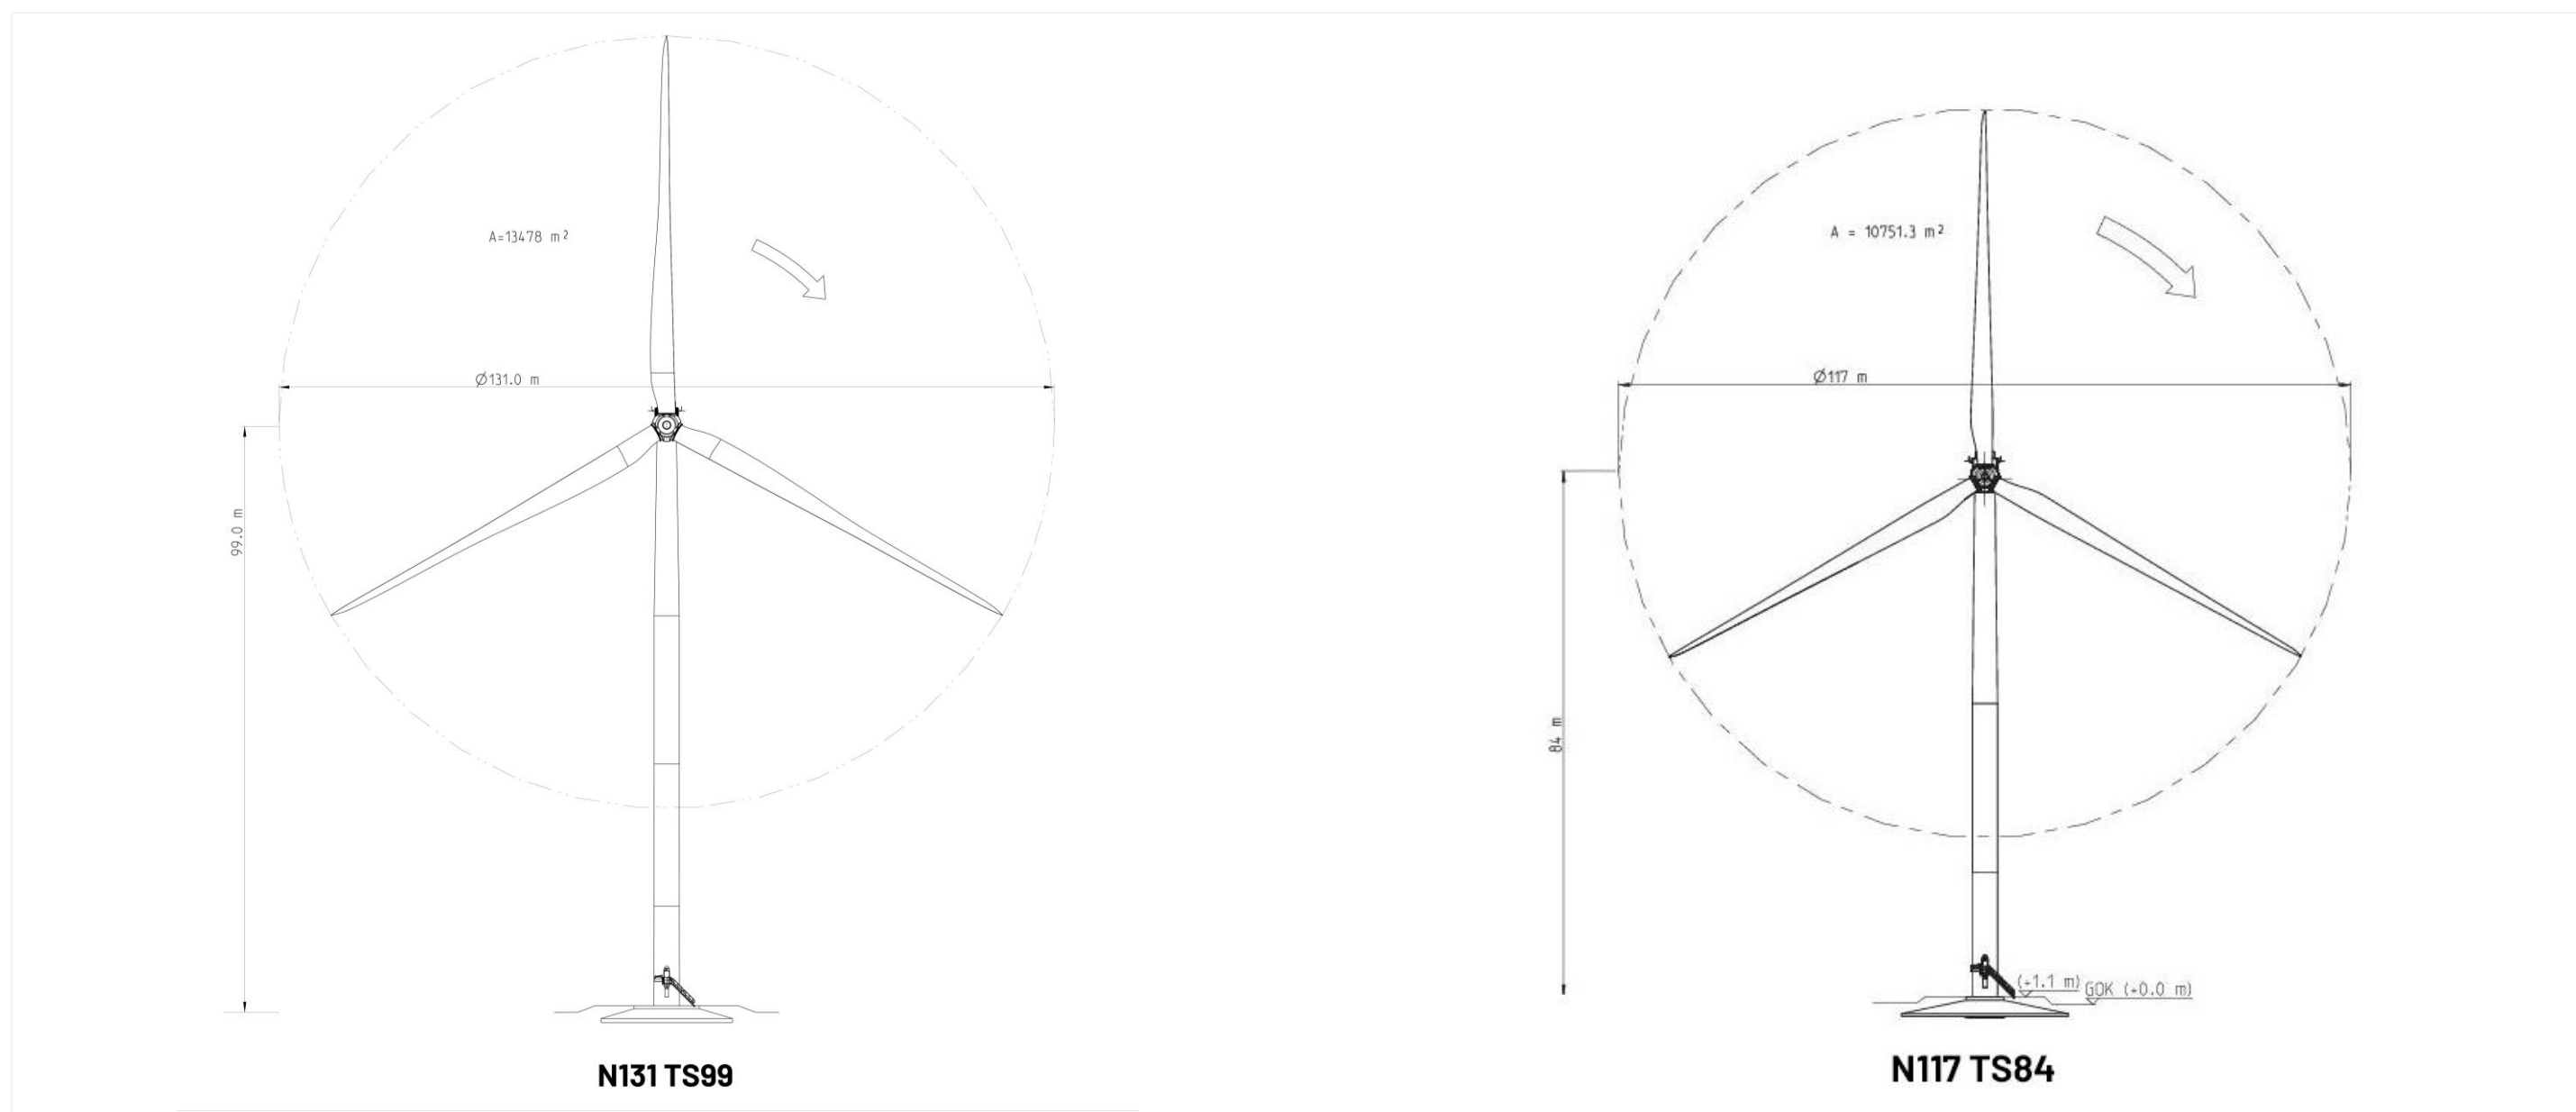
Plan de façade des modèles N131 TS99 et N117 TS84 (Source : Nordex)
